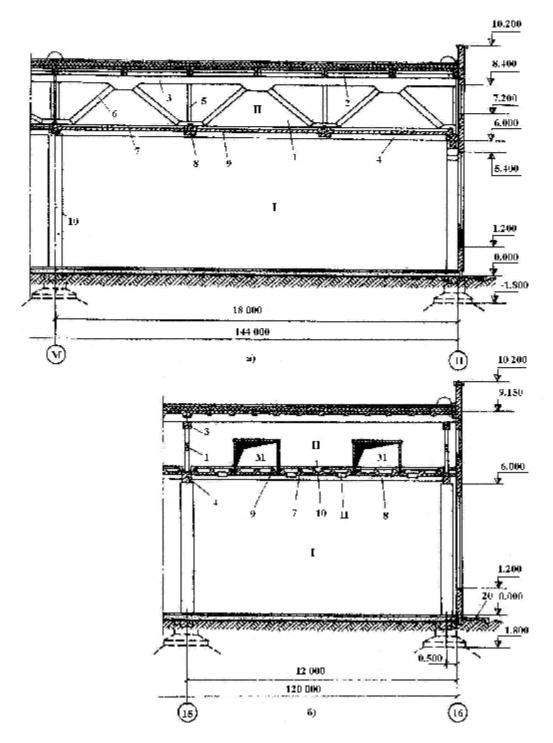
Разрезы одноэтажного бесфонарного производственного здания с техническим этажом (а – поперечный разрез; б – продольный разрез): І – первый этаж; ІІ – технический этаж; М – вентиляционный короб; Н – отверстие для светильника люминесцентного освещения; 1 – стропильная ферма; 2 – крупнопанельная кровельная плита покрытия; 3,4 – верхний и нижний пояса стропильной фермы; 5,6 – стойка и раскос решётки стропильной фермы; 7 – подвесное перекрытие технического этажа; 8 – главная балка подвесного перекрытия; 9 – плита настила подвесного перекрытия с отверстием для вентиляции; 10 – плита настила подвесного перекрытия с отверстием для светильника
